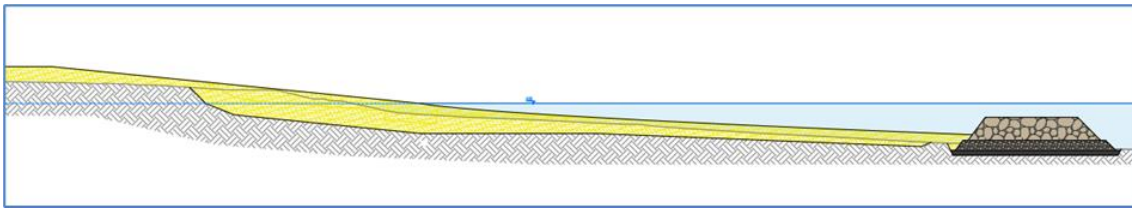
Realizzazione del ripascimento: sezione trasversale tipologica di progetto
